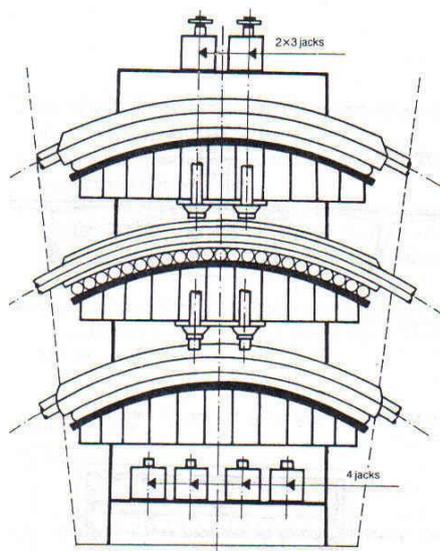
Apoyo ancho semicircular con placas de sujeción
